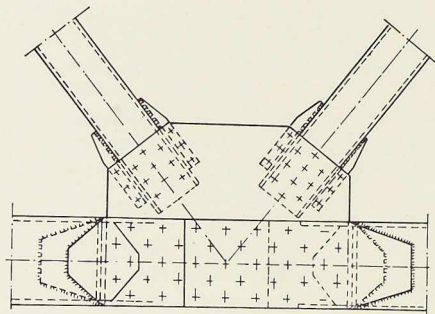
Détail d'une poutre en treillis assemblée par rivure et soudure.
